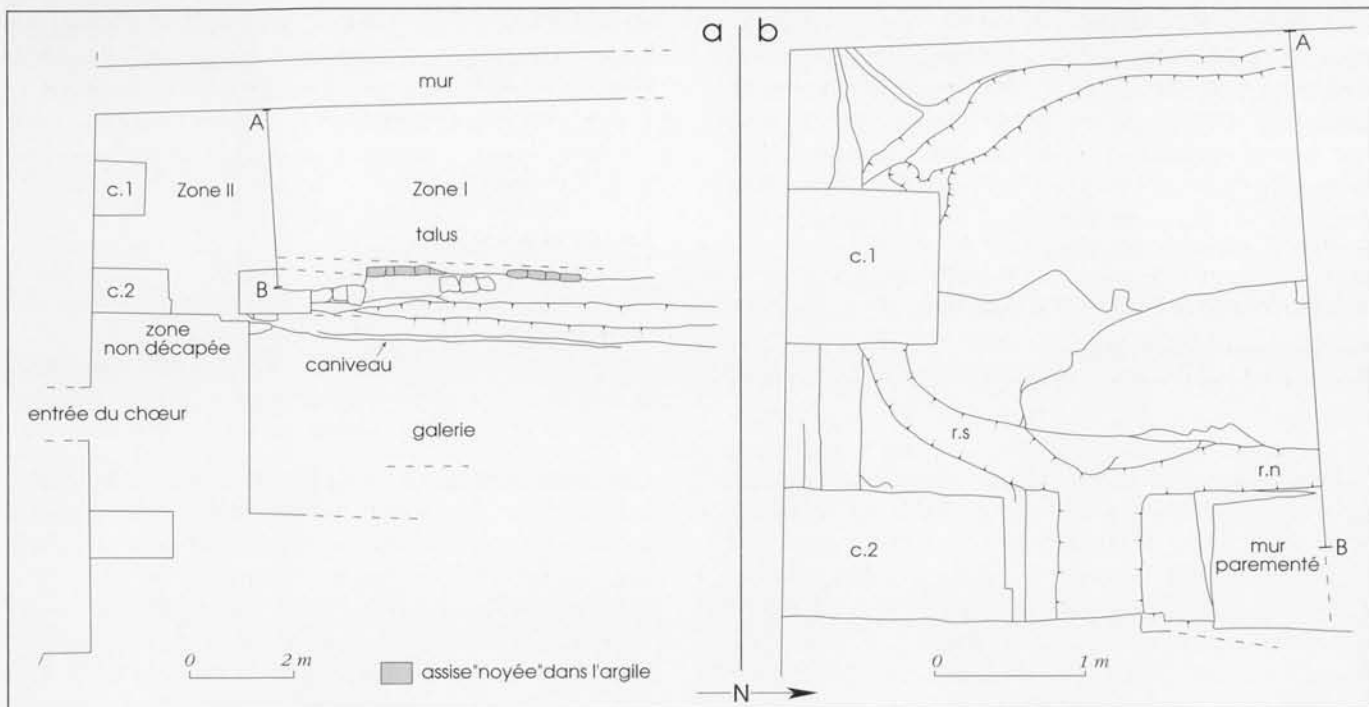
CÉRESTE, Prieuré de CarLuc. a : plan des zones I et II. b : plan détaillé de la zone II.
